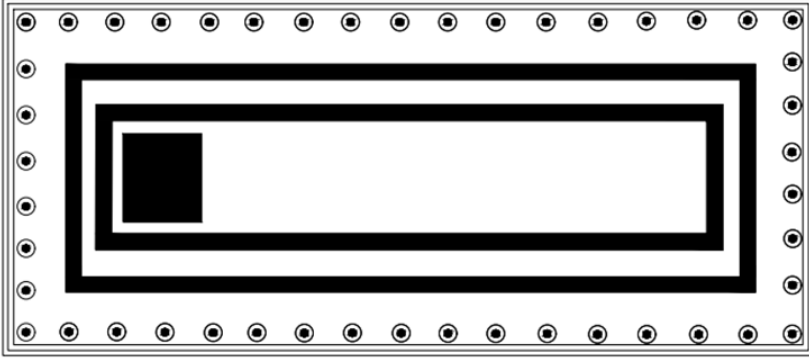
Klopedi B Tapınađı Planı Rekonstruksiyonu.
